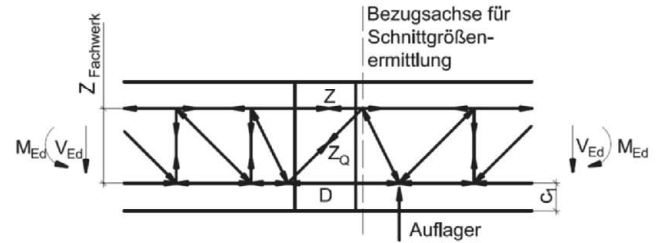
Schöck Isokorb® Typ K, K-F (Variante mehrteilig), mit Druckelementen aus Stahl
